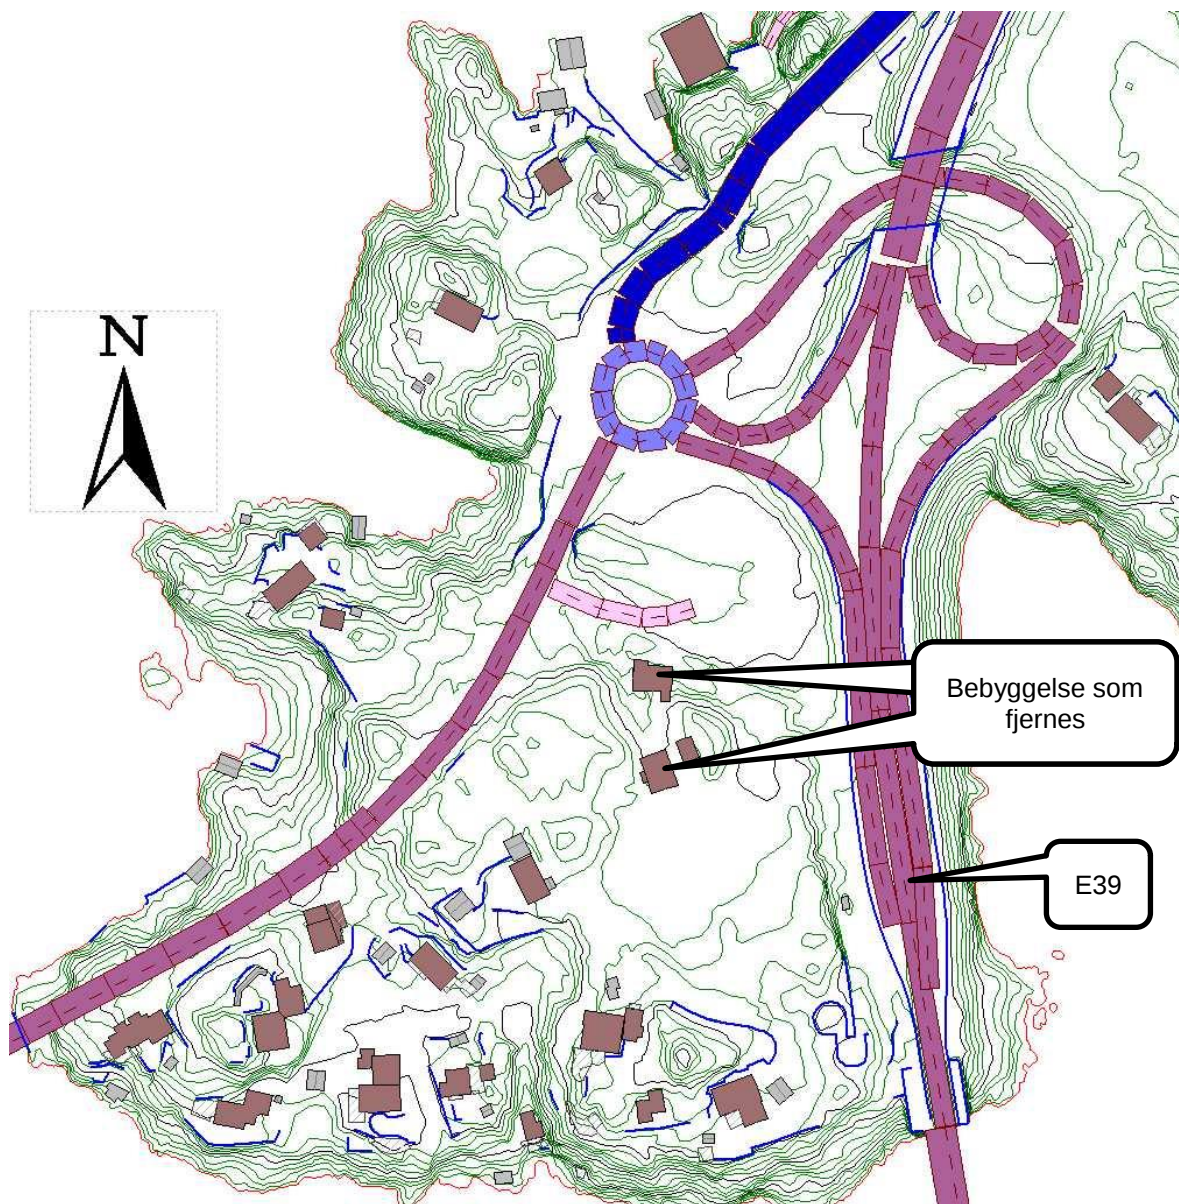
Situasjonsplan for fullt utbygget kollektivknutepunkt.
